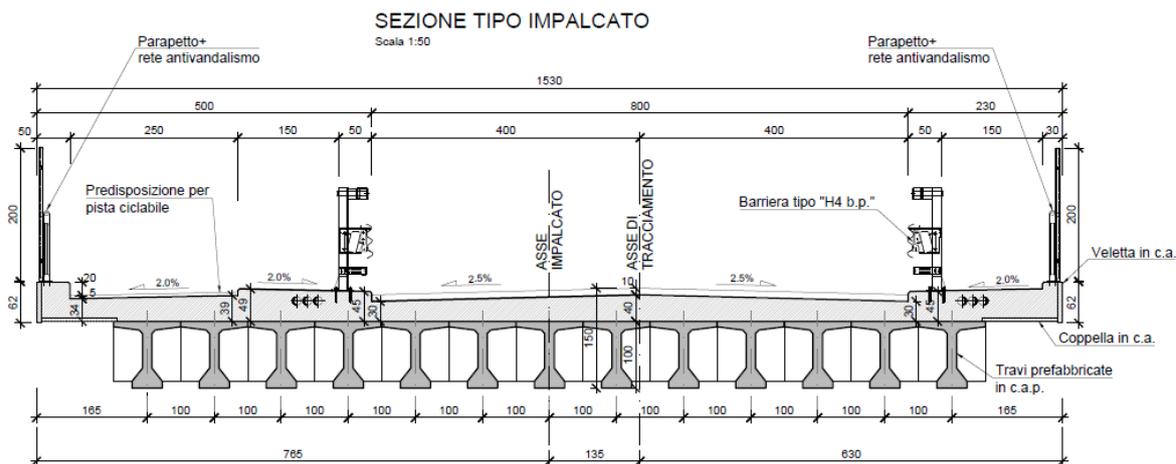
Sezione trasversale impalcato (sezione in campata)
